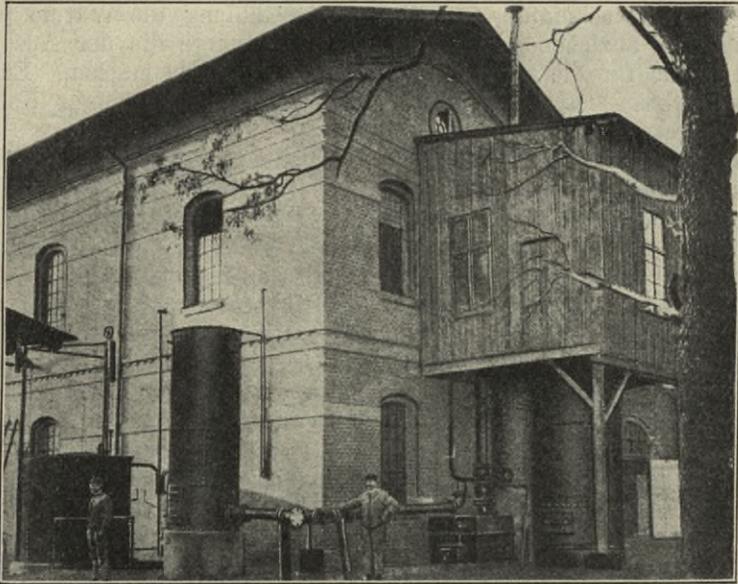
Frühere Schlammvergasungsanlage auf der Kläranlage in Ober-Schönevide (Berlin).
